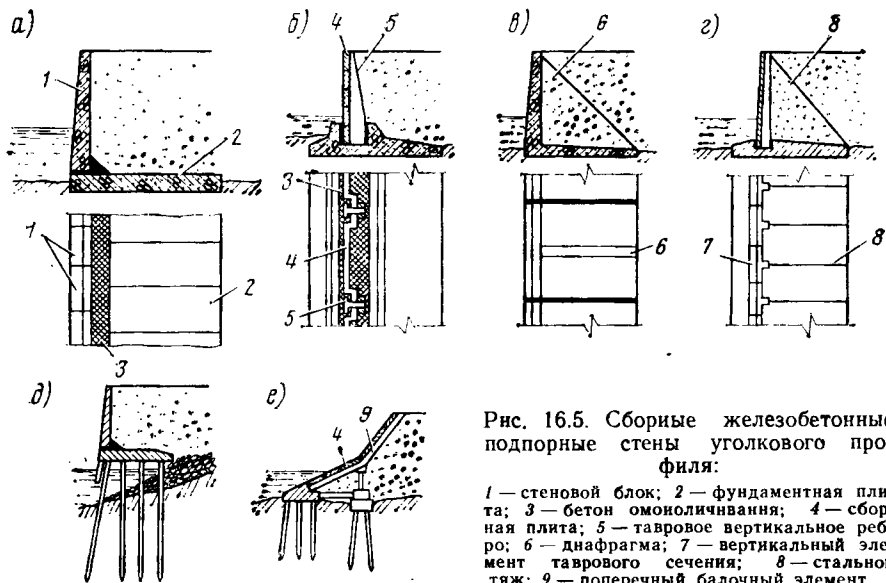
Сборные железобетонные подпорные стены углового профиля:
